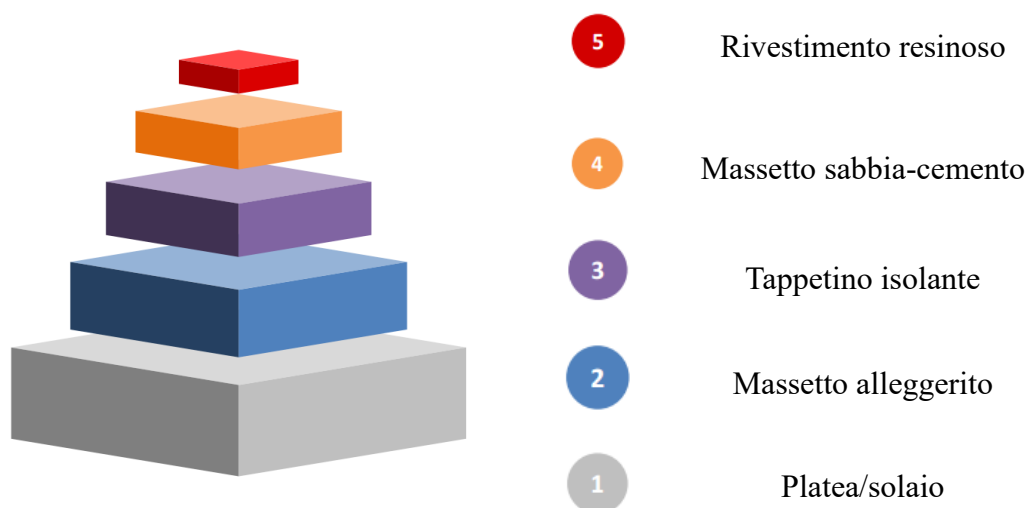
Rappresentazione schematica del sistema pavimento con copertura epossidica
